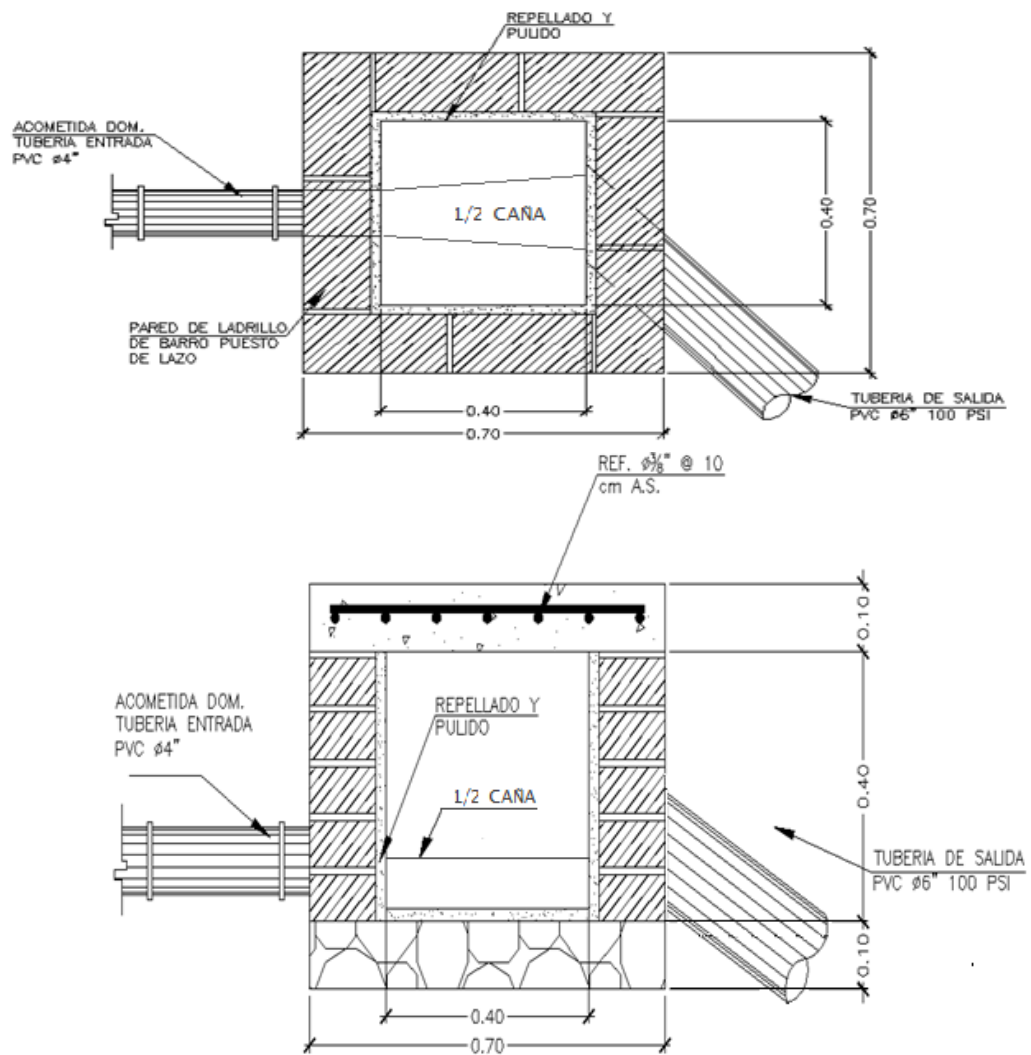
Caja de conexión vista de perfil y planta (fuente ANDA)
